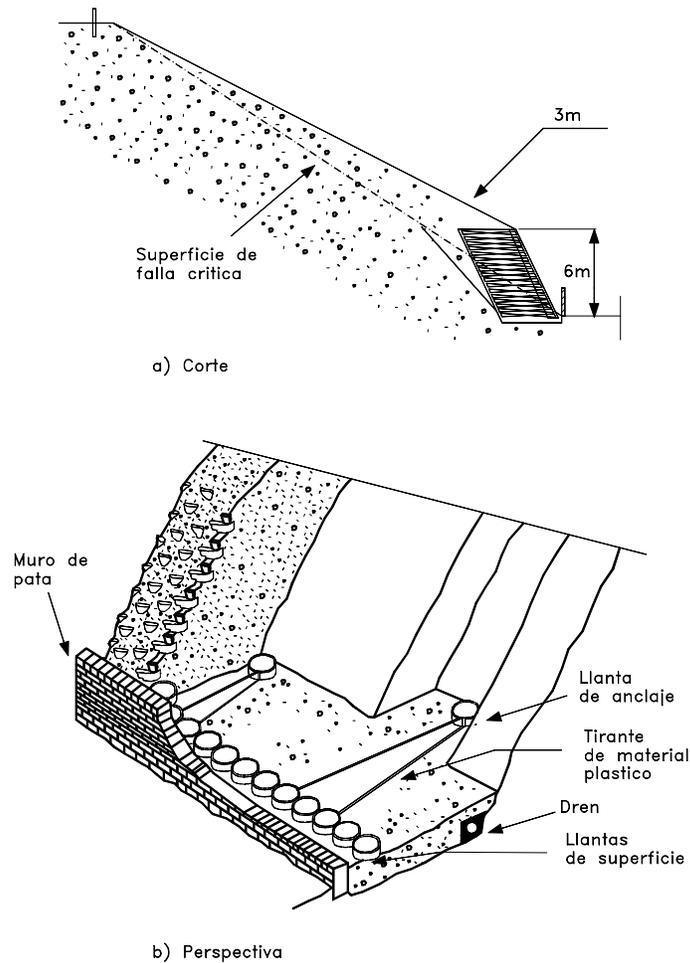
Muro armado con llantas usadas, utilizando llantas con tirantes como elemento de anclaje.
